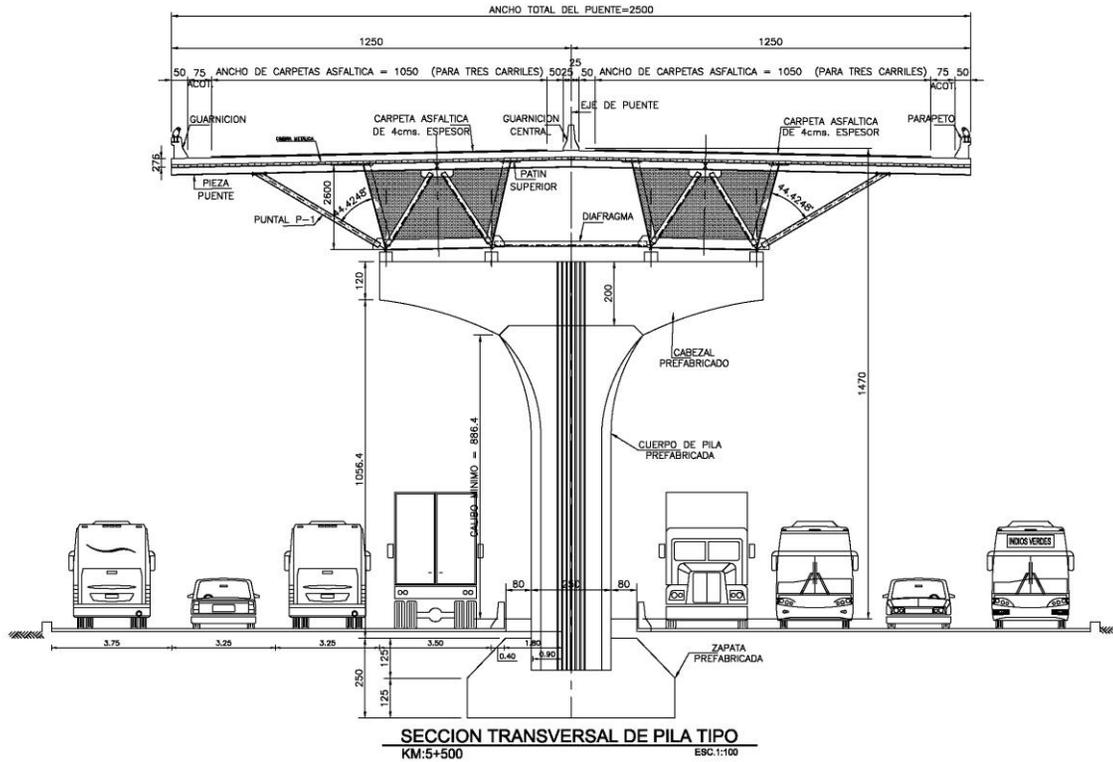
Sección transversal tipo para tramos de tres carriles por sentido A6 cimentados con zapatas
